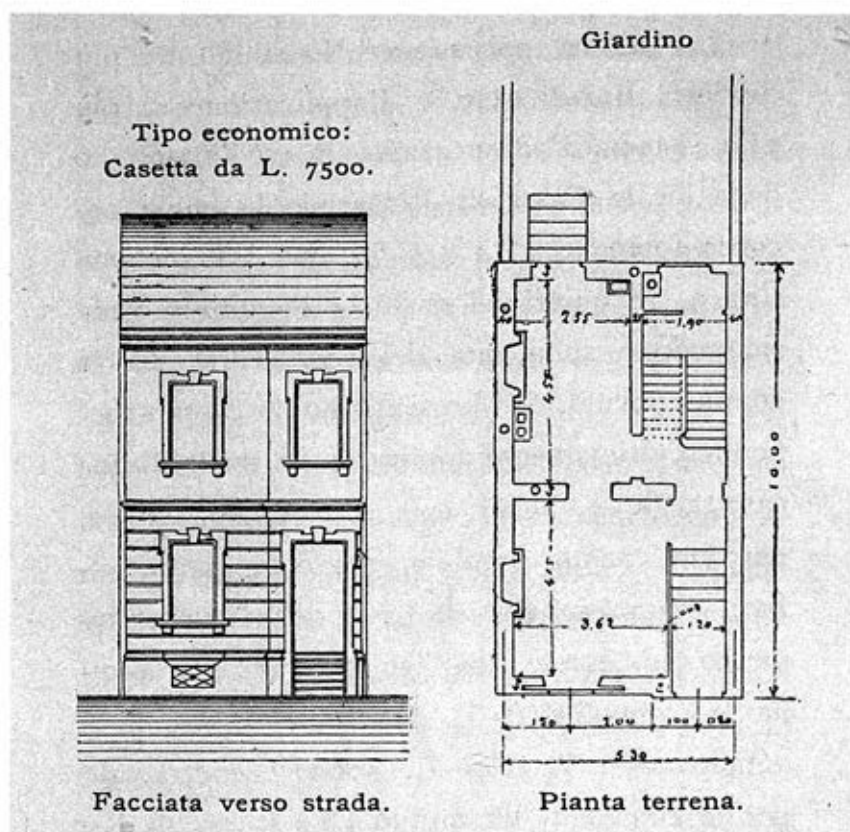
Tipo di casetta economica, prospetto e pianta.
